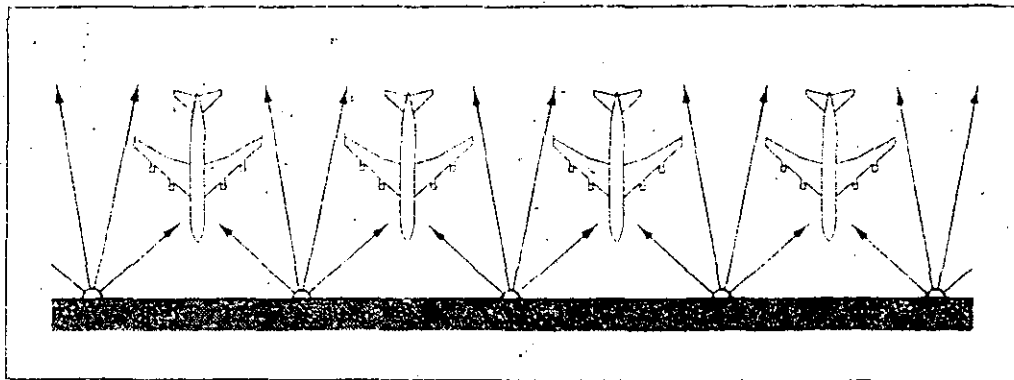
Colocación y dirección típicas para el estacionamiento con la proa hacia adentro
